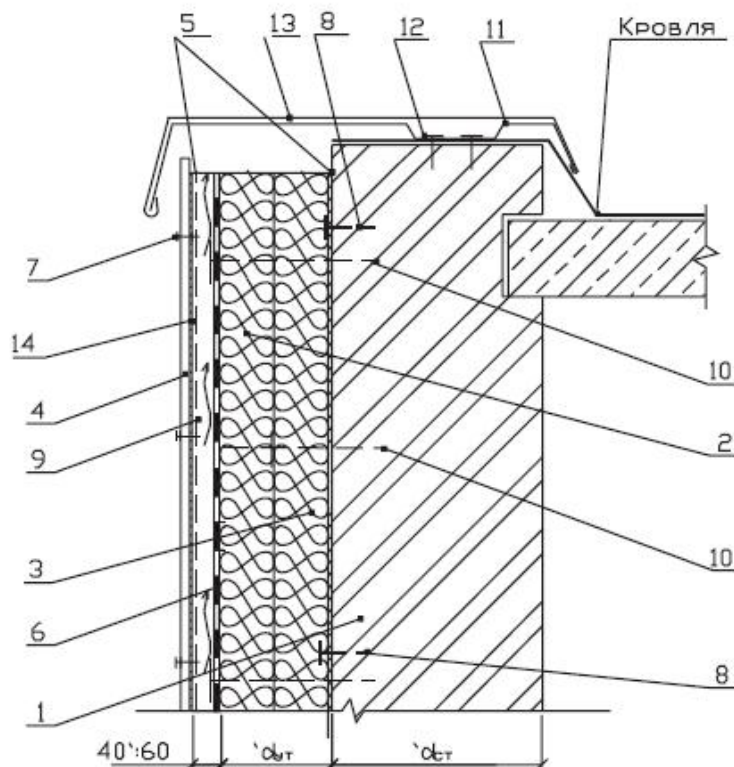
Вентилируемый фасад с применением плит марки "ТЕРМОВЕНТ" с облицовкой плитным материалом. Горизонтальный шов.
